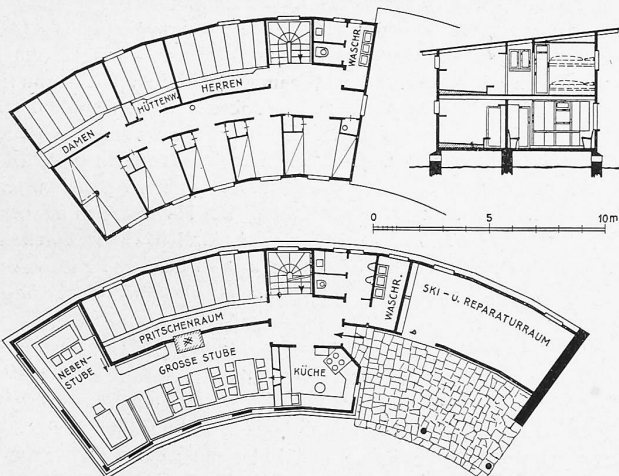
Ortstockhaus, Grundrisse und Schnitt. — 1 : 300.
